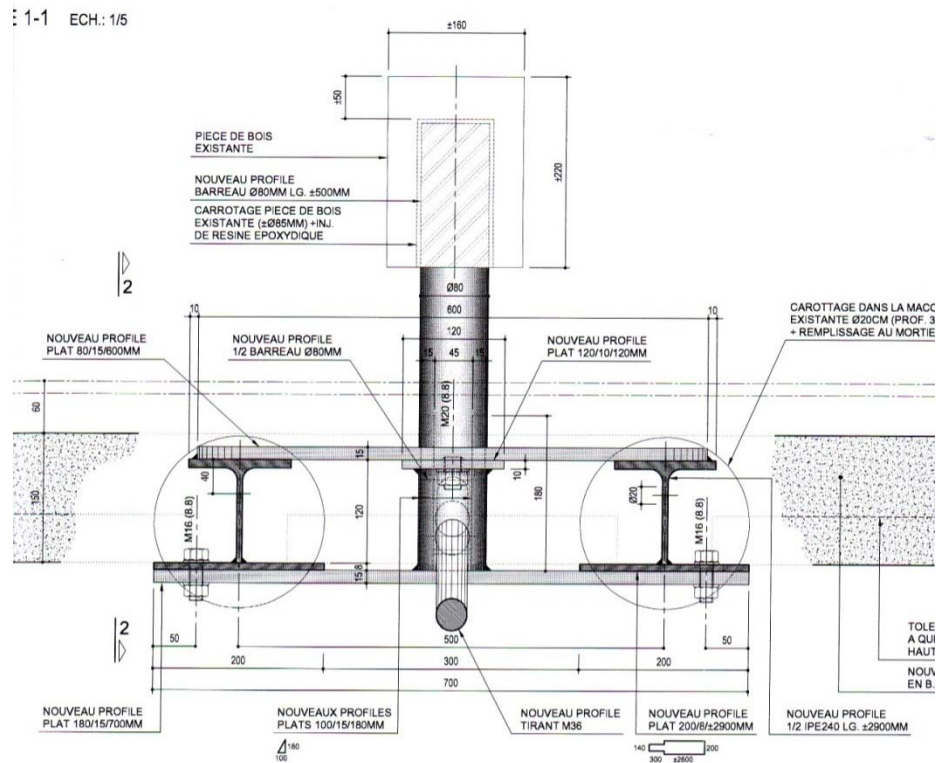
Le profilé barreau reliant le plancher à la charpente. (Plans-d'exécution, 2007)
